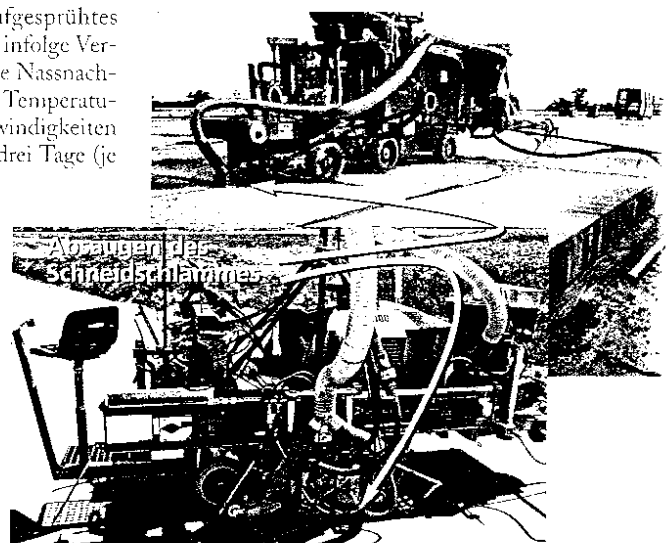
Mit modernen Fugenschneidgeräten wird der anfallende Schneidschlamm unmittelbar am Schnitt abgesaugt, hier: Schneidmaschinen für die Quer- und für die Längsfugenschnitte.
